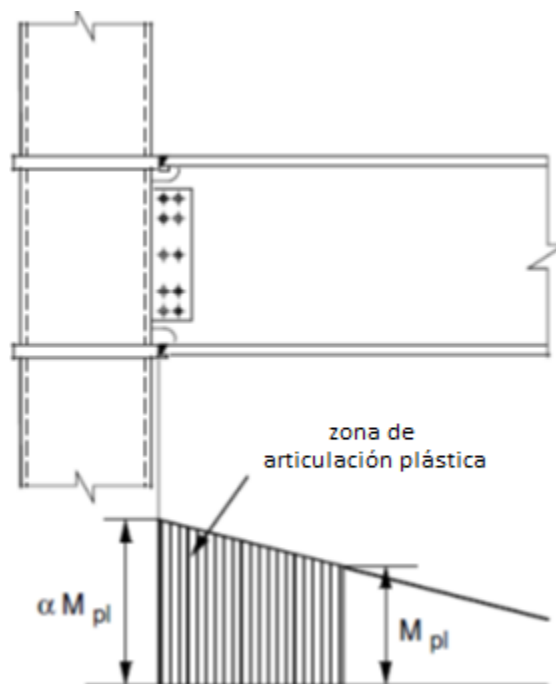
Ejemplo de unión viga-columna bajo cargas horizontales. [15]
